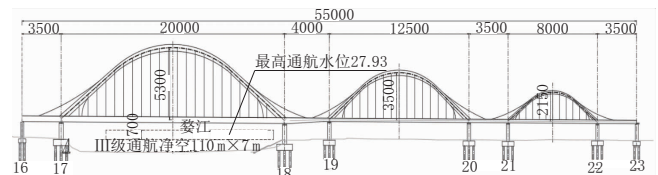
婺江大桥主桥总体布置立面图(单位:cm)
